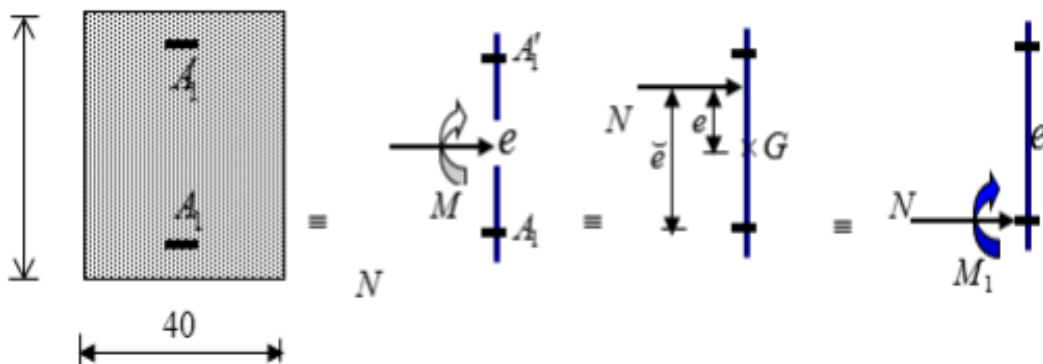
Position de N_1 , M_1 et M'_1 sur la section transversale.
